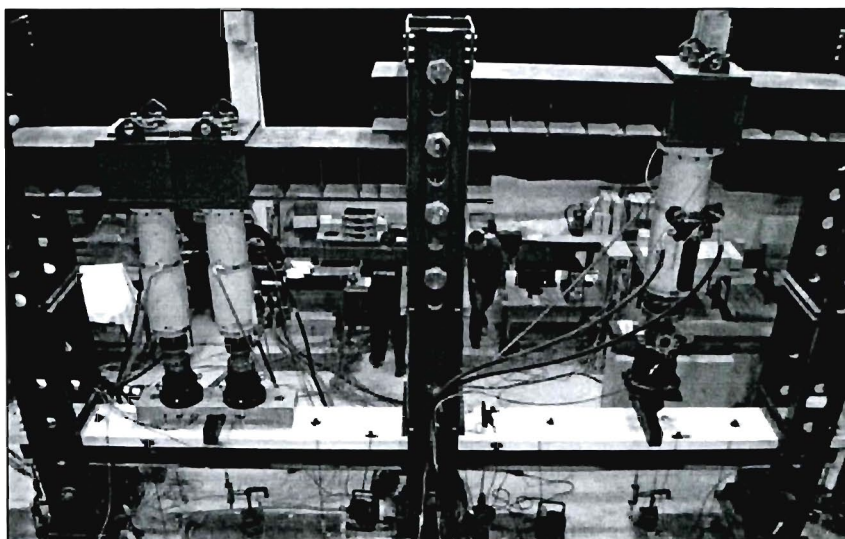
Widok elementu badawczego po zabetonowaniu
